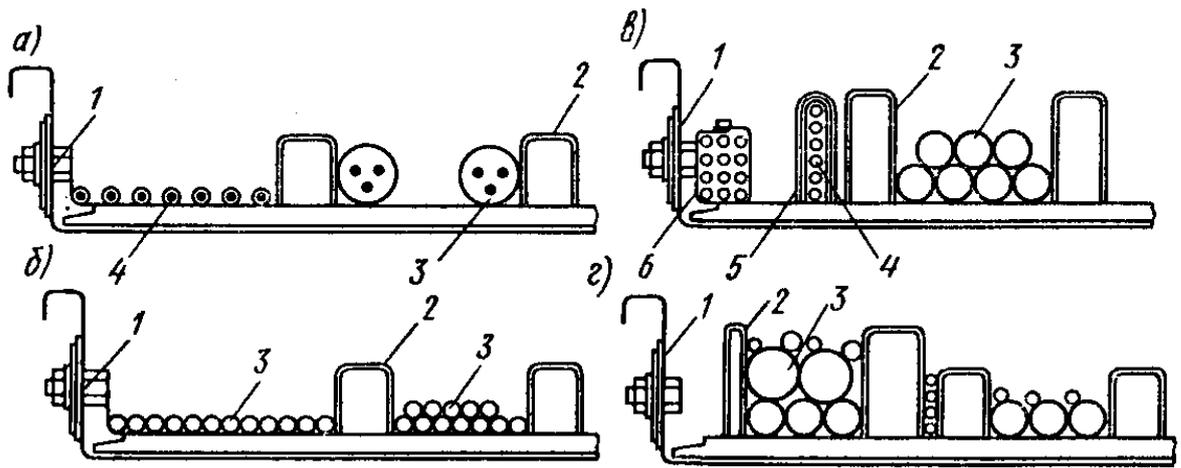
Прокладка проводов и кабелей на лотках: а - рядовая; б - сплошная однослойная и двухслойная; в - пакетами и пучками; г - пучками; 1 - лоток; 2 - разделительная обойма; 3 - кабели; 4 - провода; 5 - прижимная обойма; б - охватывающая обойма
